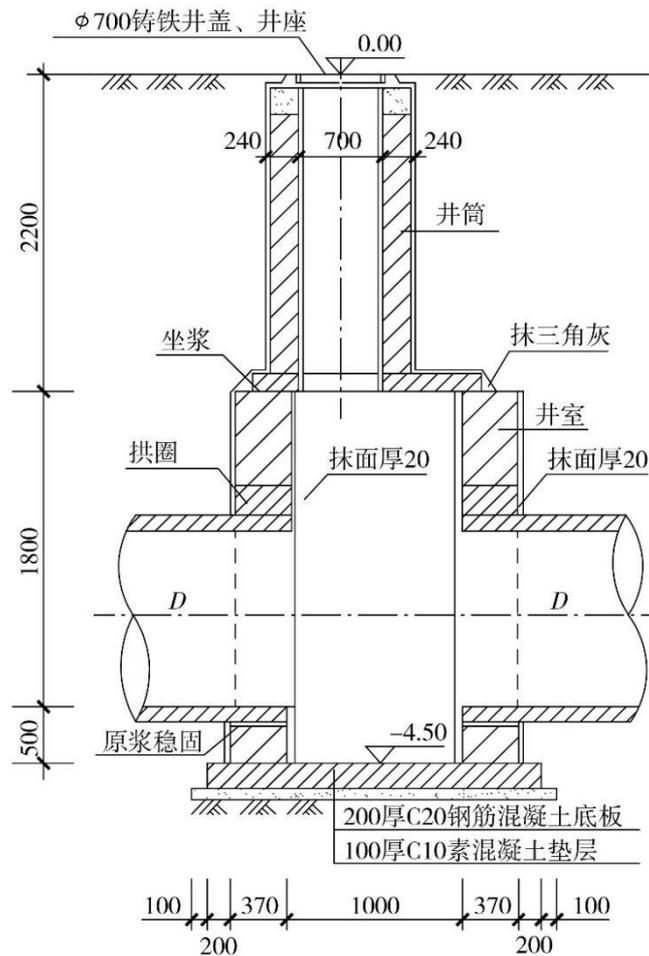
1#检查井剖面图（标高单位：m，尺寸单位：mm）
